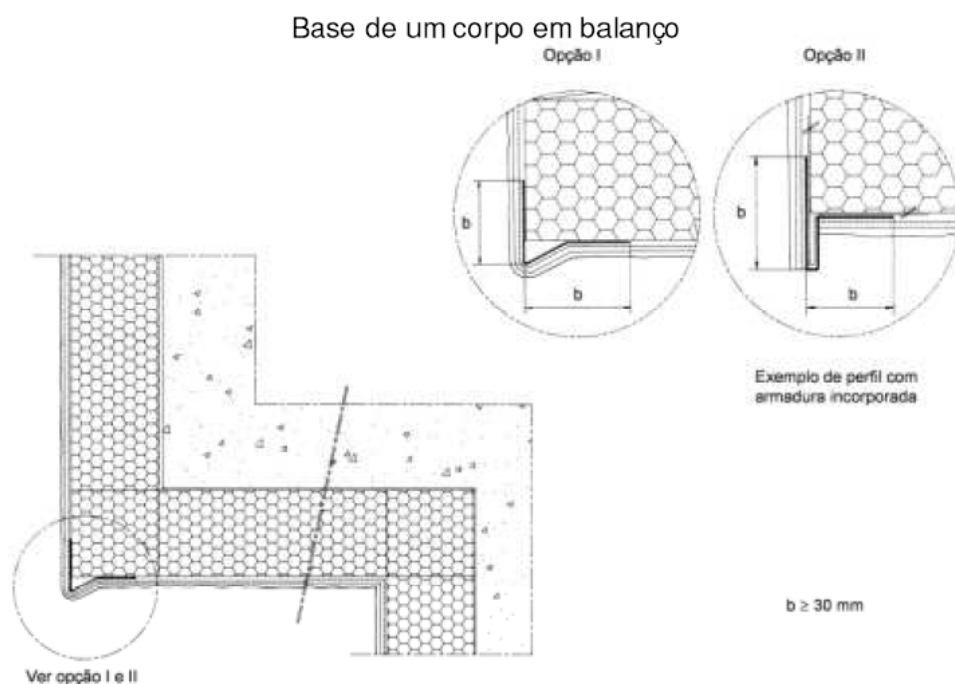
Aplicação do ETICS – Perfil de arranque do limite inferior do sistema [7]
